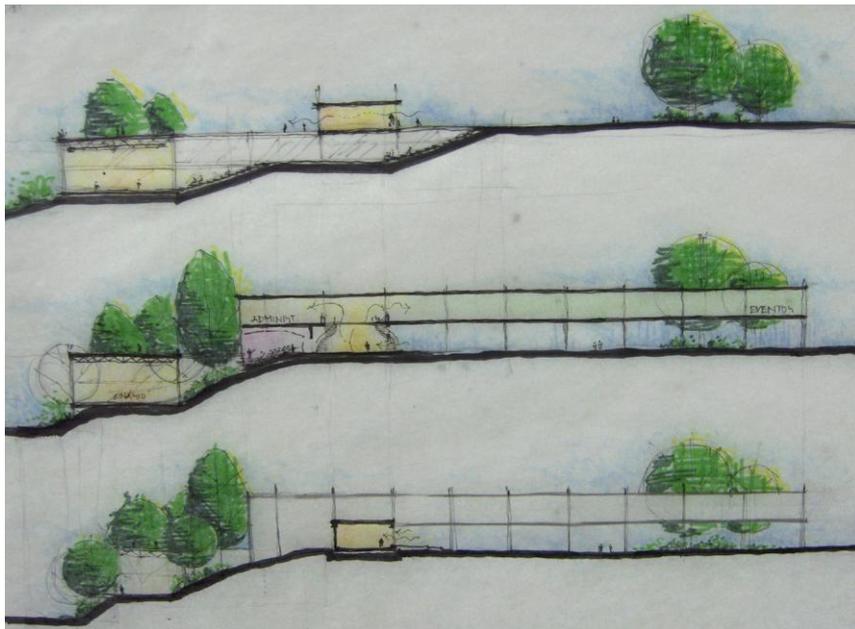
TRABALHO DE ALUNO - Cortes da edificação
